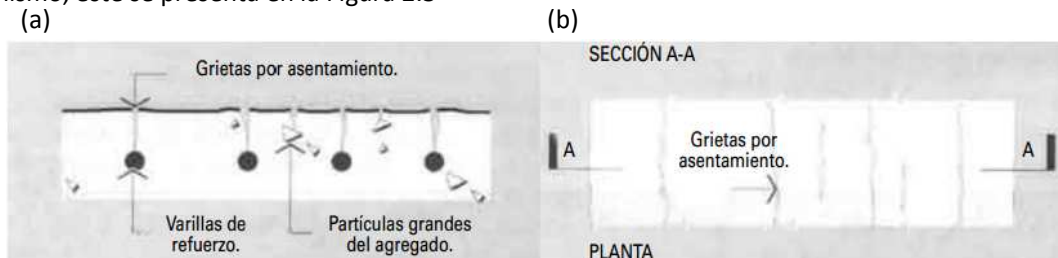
Mecanismo del Asentamiento plástico (Instituto Mexicano del Concreto, 2002) (a) Mecanismo que genera la fisuración (b) Patrón de fisuración
